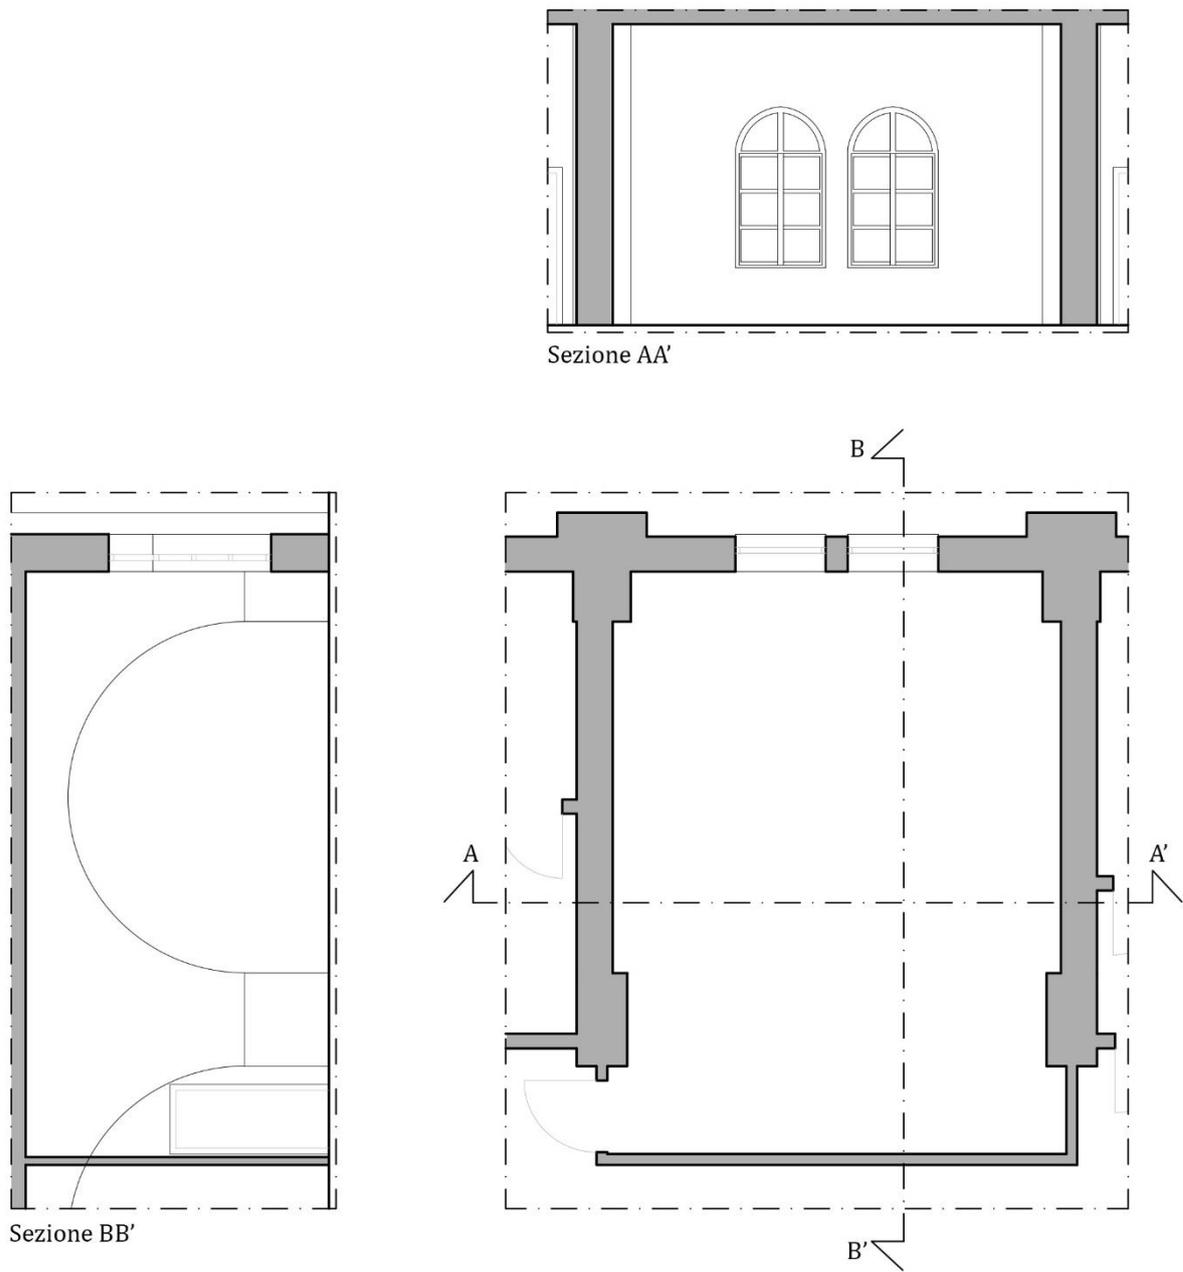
Pianta e sezioni in scala 1:100 dell'aula nord-est del primo piano.
